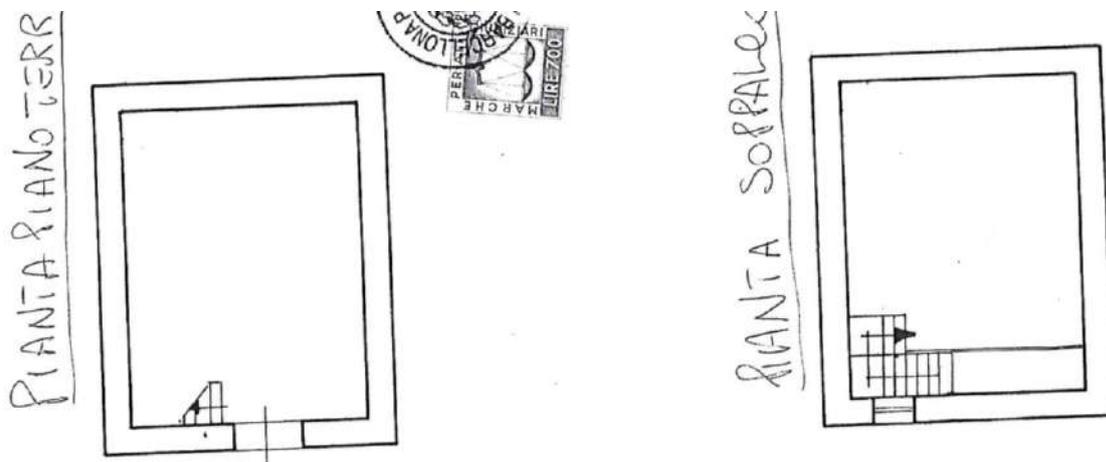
Planimetria dell'immobile fg.98 part. 403 sub.1 come da perizia del C.T.U. Cicero
